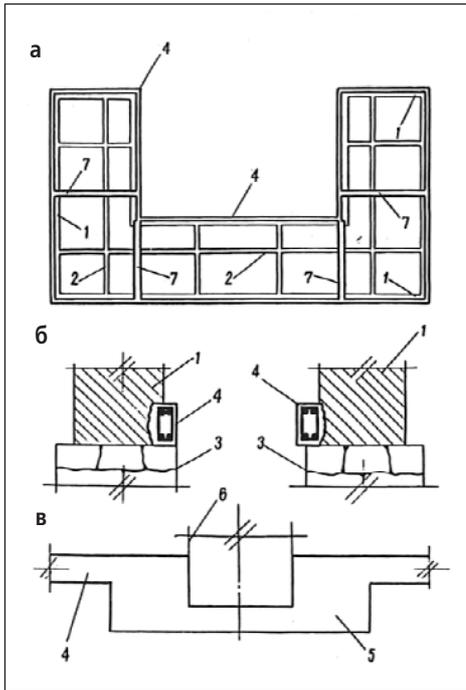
Схема устройства железобетонного цокольного пояса: а – план, б – сечения пояса, в – усиление пояса в месте разрезки его дверным проемом; 1 – наружная стена, 2 – внутренняя стена, 3 – фундамент, 4 – цокольный пояс, 5 – местное усиление цокольного пояса, 6 – дверной проем, 7 – железобетонная связь-распорка
